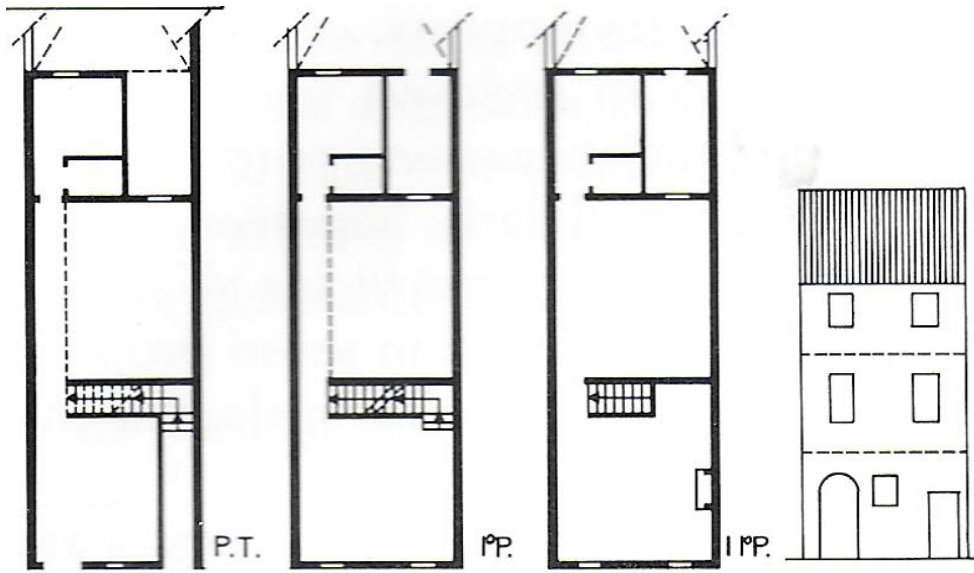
Plantas y alzados casa adosada a vestíbulo plurifamiliar.
